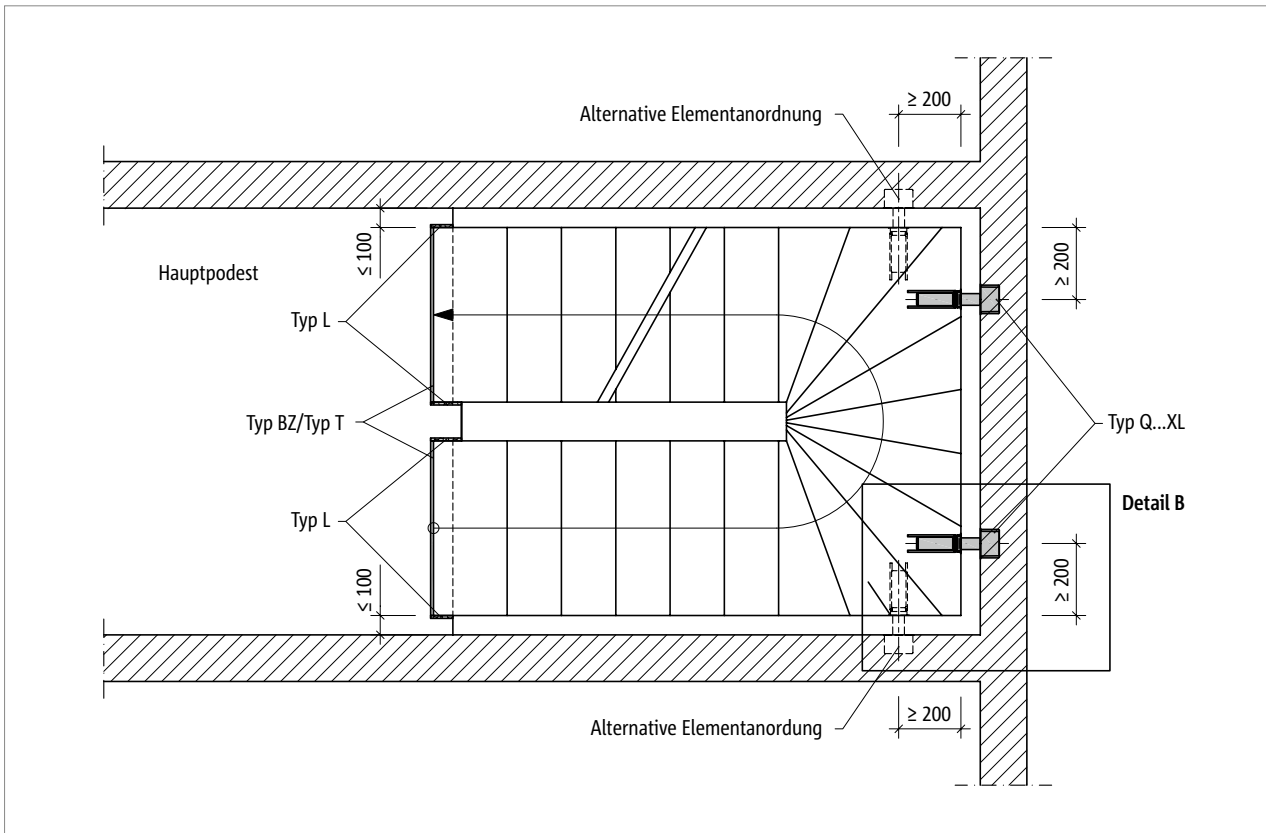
Schöck Tronsole® Typ Q: Elementanordnung im Grundriss mit Verwendung der Tronsole® Typ L
